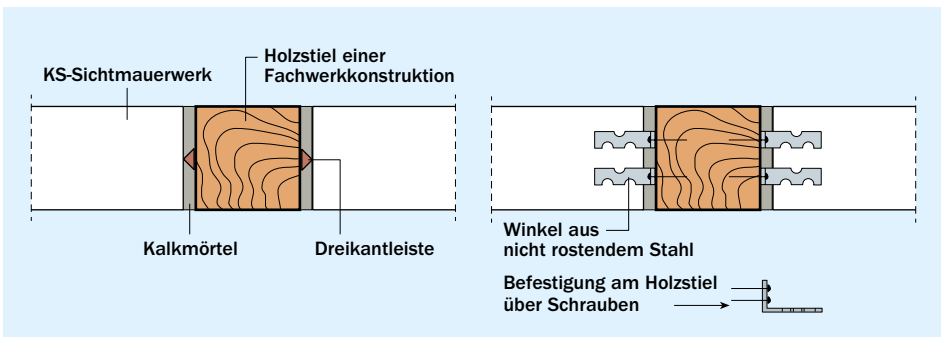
Wandanschluss von KS-Sichtmauerwerk an eine Holzfachwerkkonstruktion
